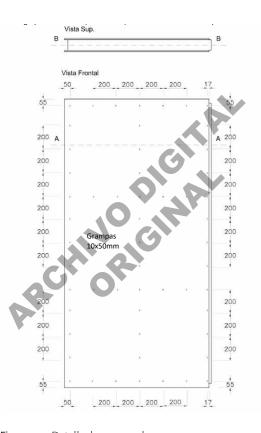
Detalle de engrapado para ensamblado de paneles (vista frontal del contrachapado). Fuente: Ñandé, 2021.
